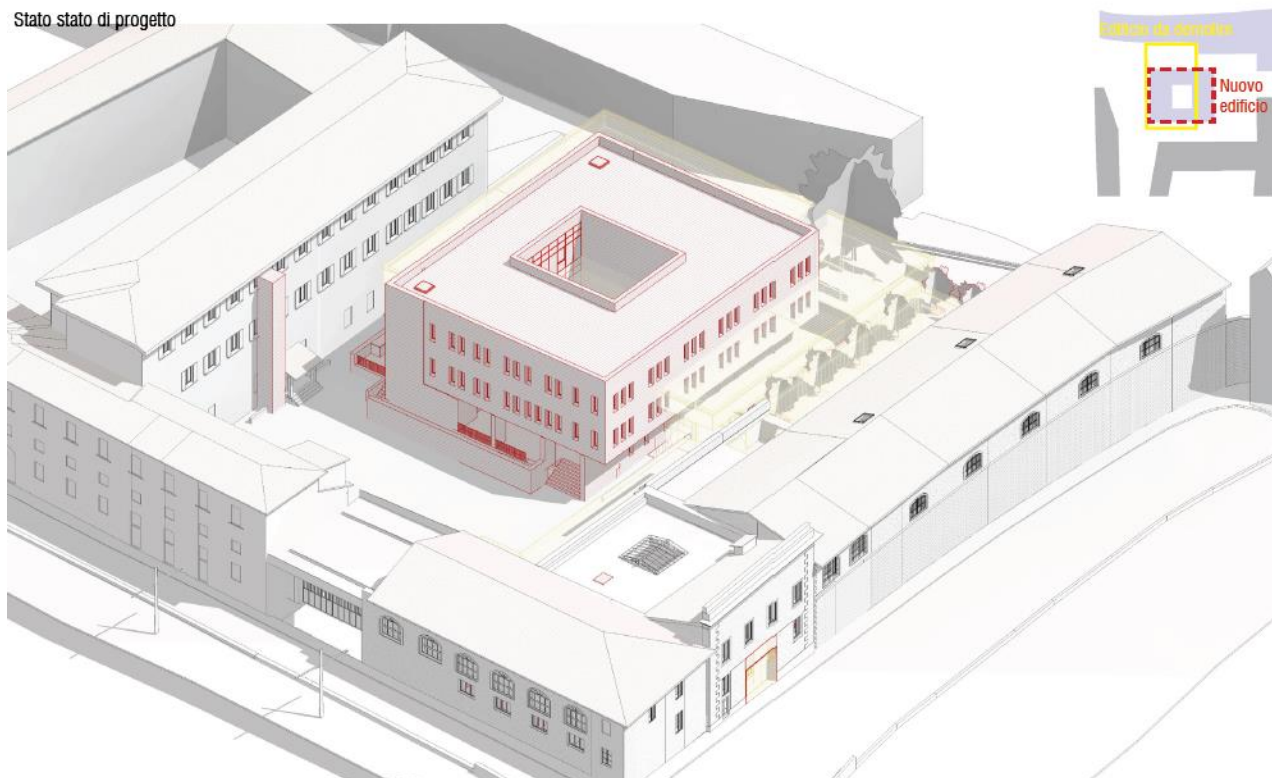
Vista schematica dello stato di fatto e stato di progetto sovrapposti
